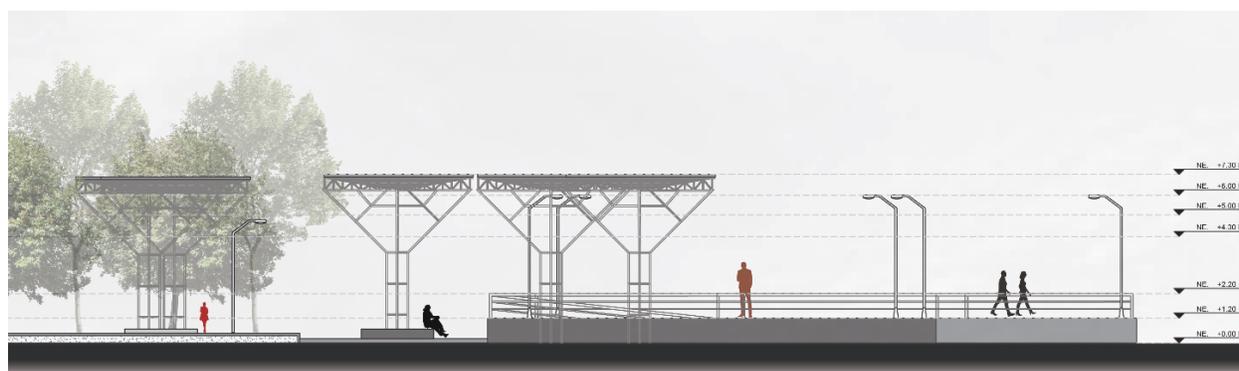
Sección Corte - perfil H-H'; Fuente: Elaboración propia
